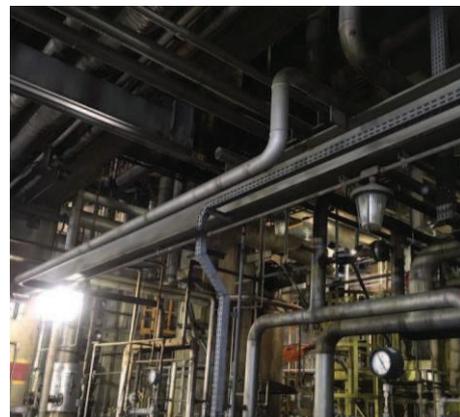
lâmpada queimada, aguardando autorização para substituição.
